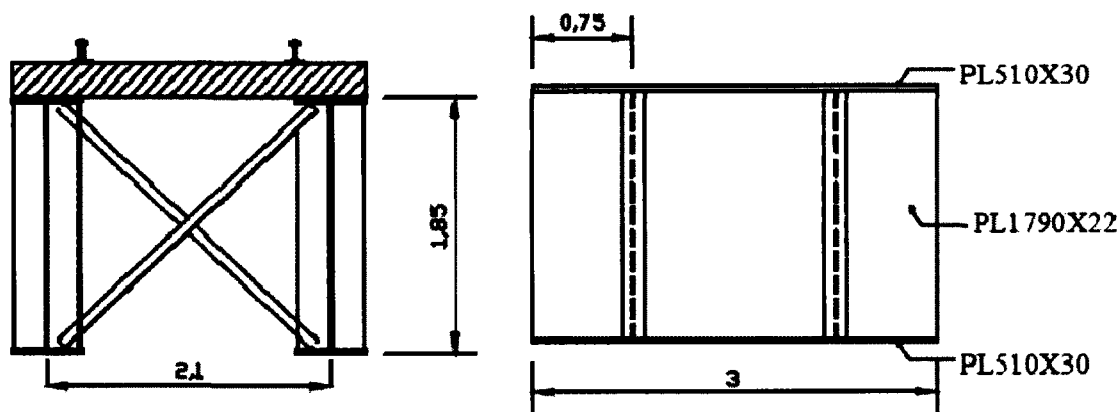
Pont bi-poutres - Section transversale et élévation - Section D-2
